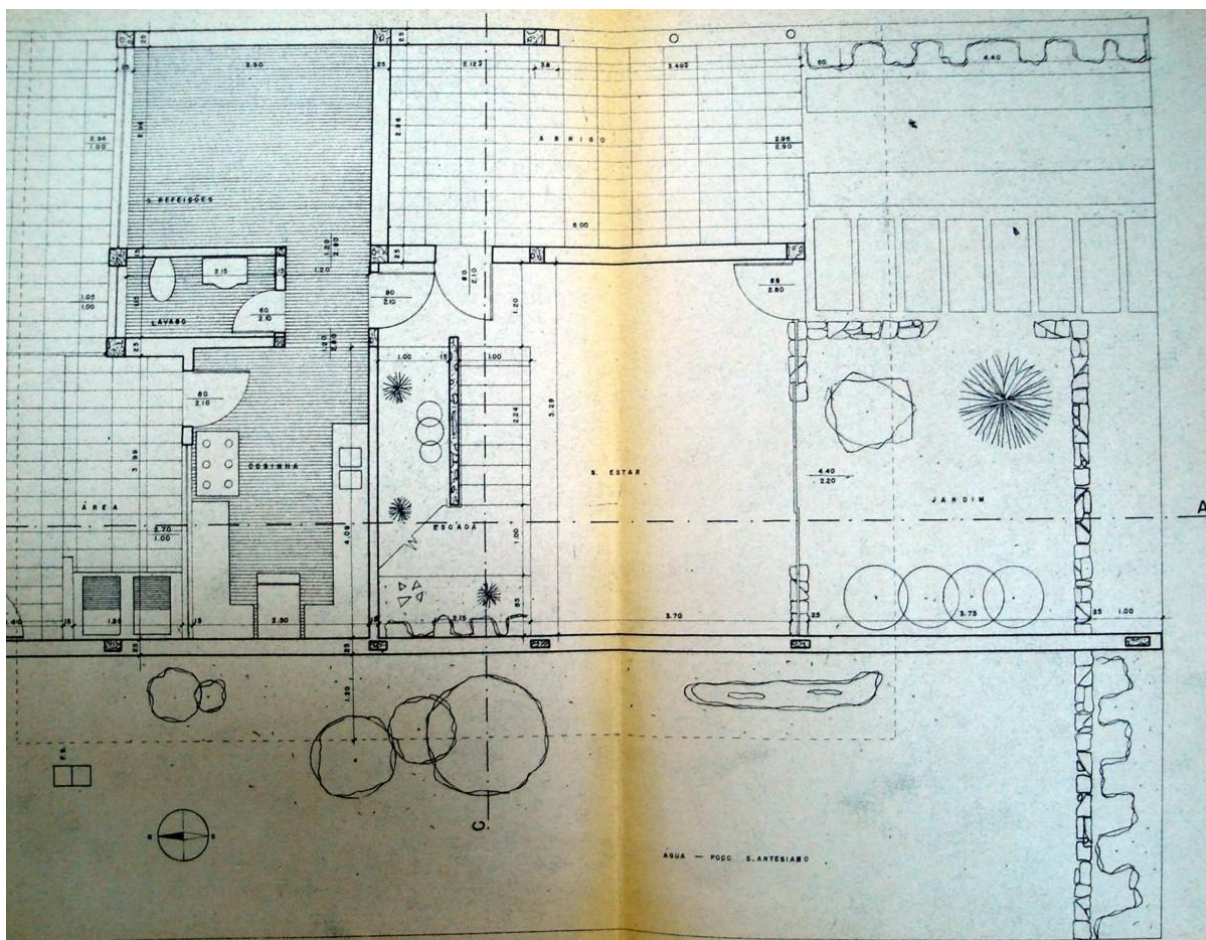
Projeto Arquitetônico / Planta do pavimento térreo (Residência da Av. XV de Novembro, n° 1200)
